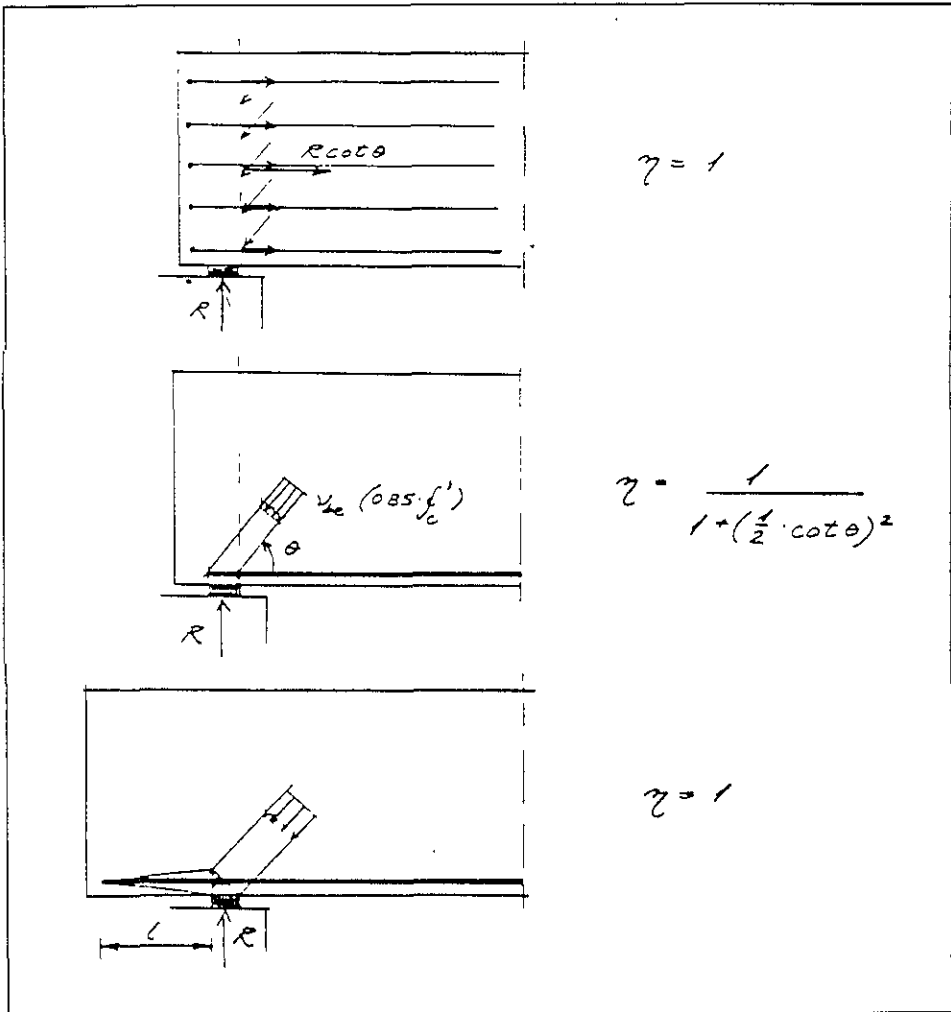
Distribuciones de esfuerzos en la zona de anclaje y apoyo
